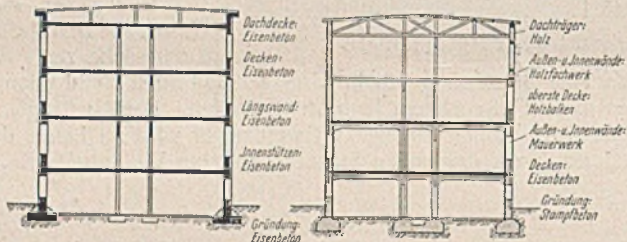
Reiner Eisenbetonbau. Abb. 2. Sparentwurf.
